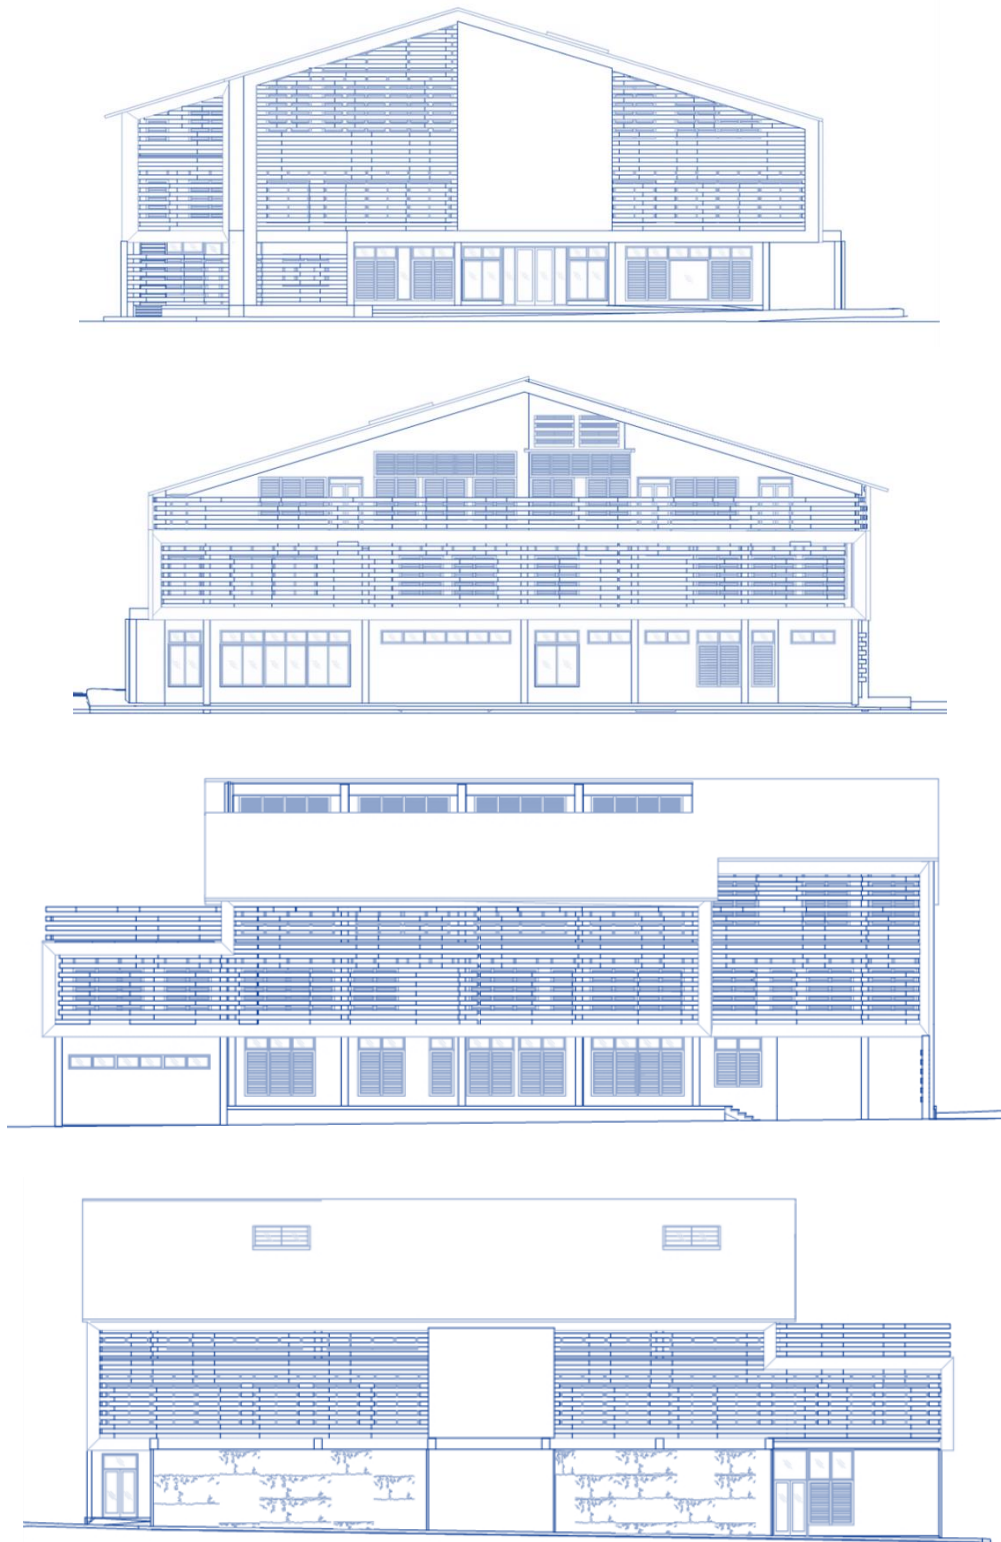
Elevaciones del edificio. En Orden descendente fachadas Este, Oeste, Sur y Norte.
